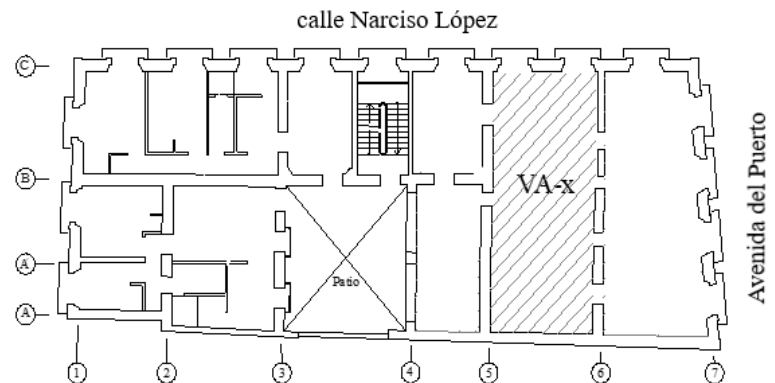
Vista en planta del primer nivel del edificio. Señalizado de la zona de estudio. Elaboración propia
